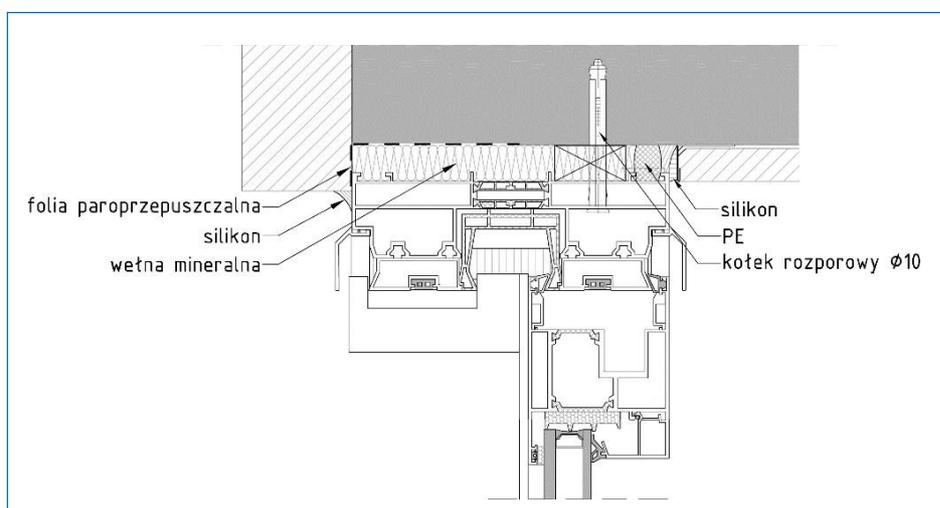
Esempio di montaggio della porta finestra in una parete solida isolata dall'esterno - sezione verticale attraverso l'architrave
